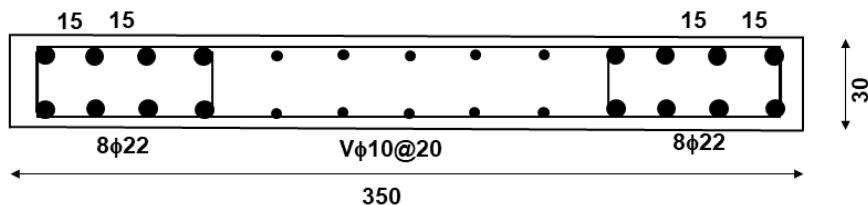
Distribución del Refuerzo Longitudinal Muros MC
